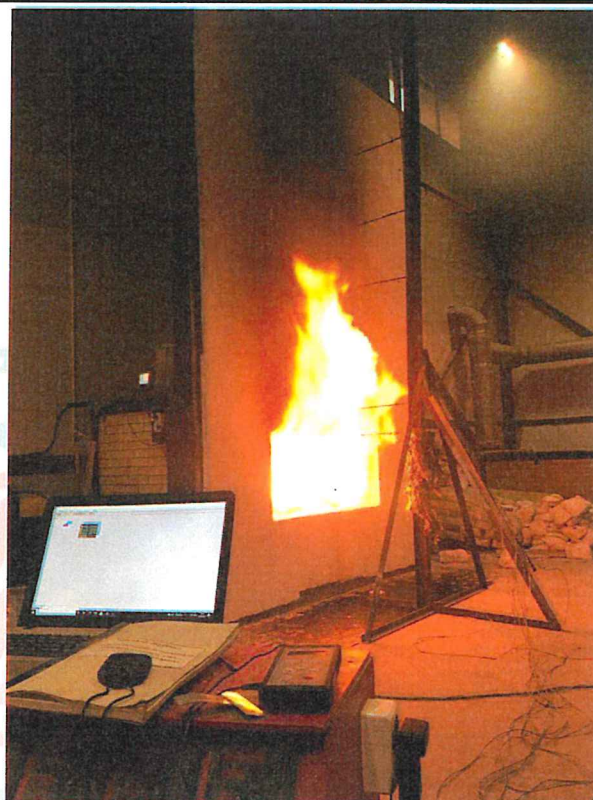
Внешний вид образца на 30-й минуте испытания.
